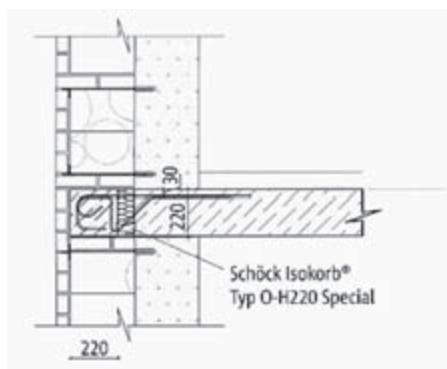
Несущий теплоизоляционный элемент Шёкк, устанавливаемый в узле опирания наружной стены на монолитное междуэтажное перекрытие.
